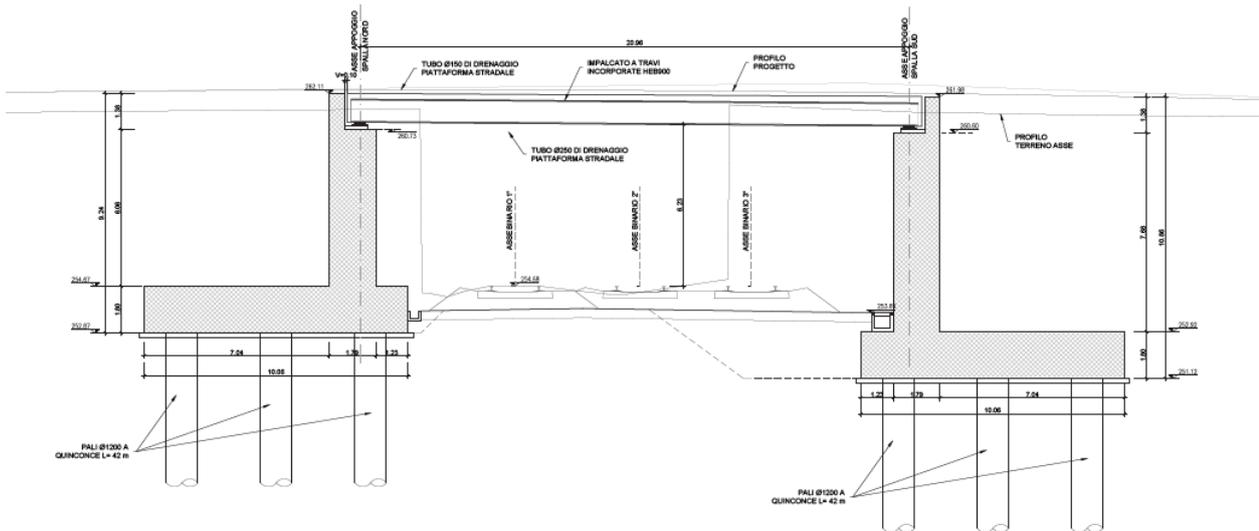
Nuovo cavalcaferrovia nella stazione di Ellera: sezione longitudinale
